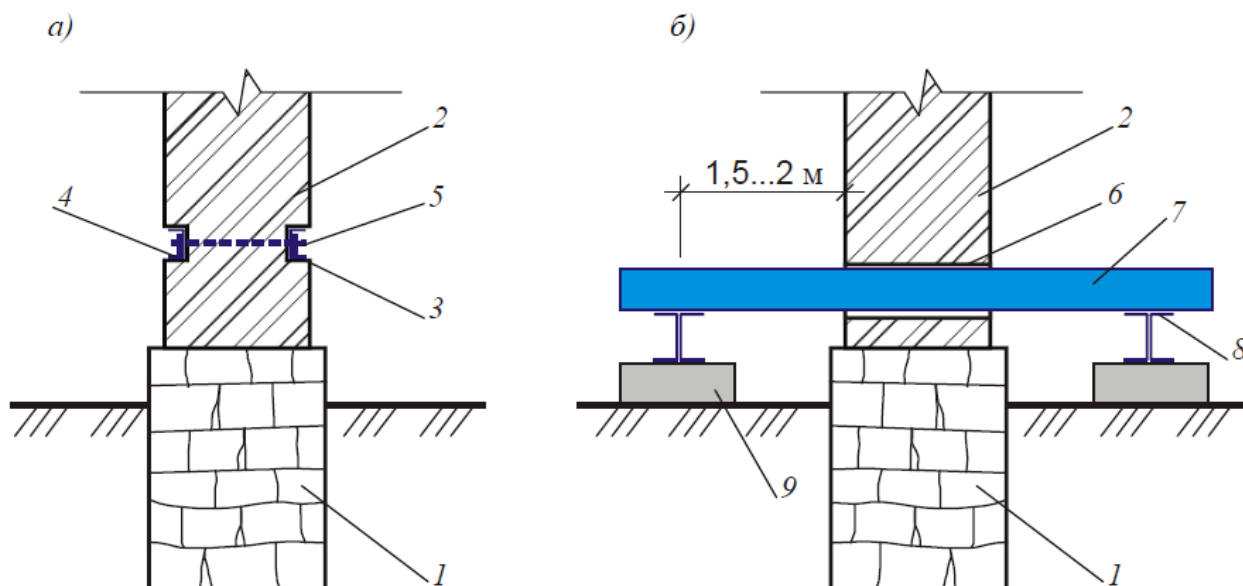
Полная разгрузка фундаментов с помощью: а – рандбалка; б – поперечных балок; 1- фундамент; 2-стена; 3-штраба; 4-рандбалка; 5-
